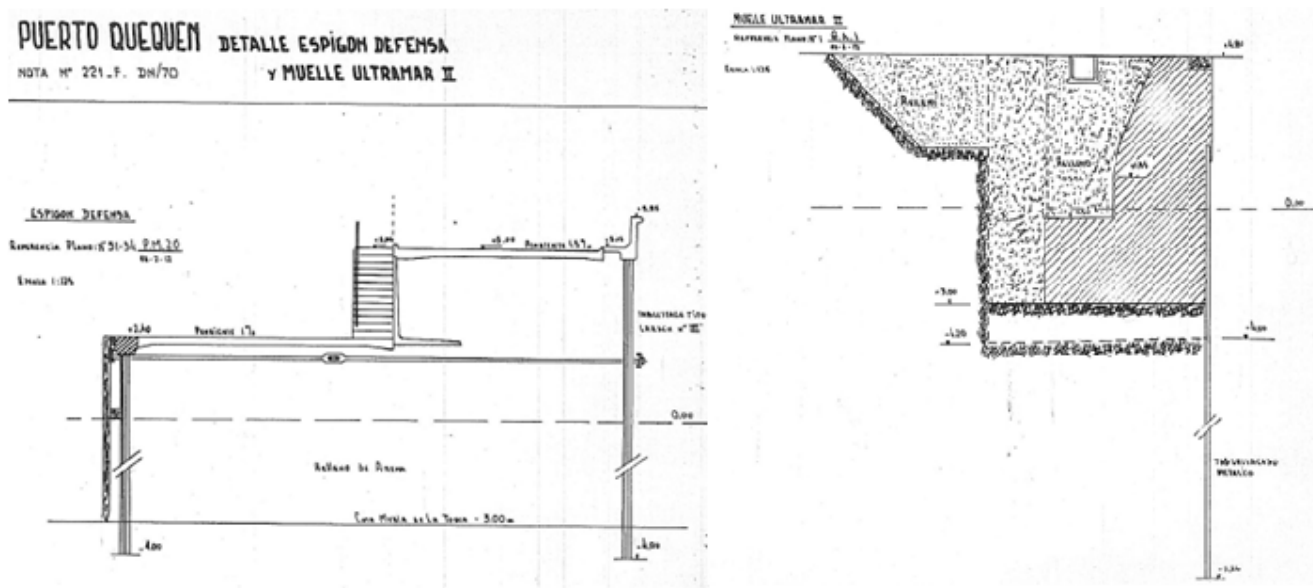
Corte Transversal del espigón de defensa y detalle del muelle de ultramar.
